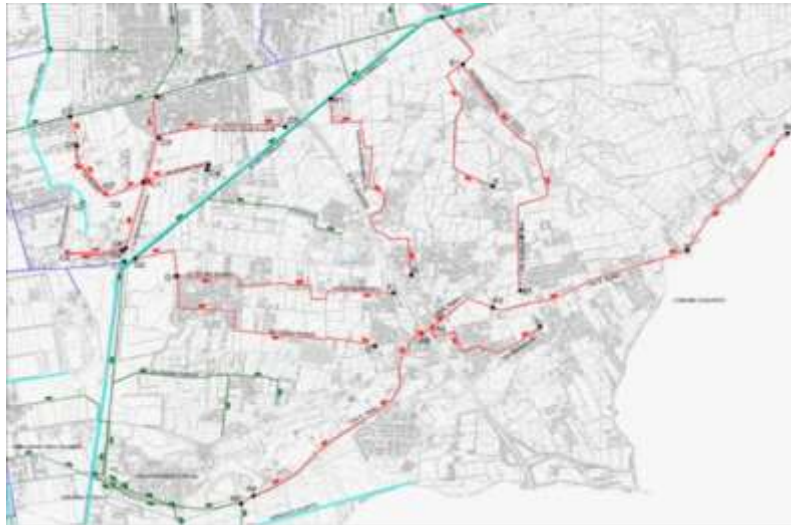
Planimetria degli interventi – Progetto Definitivo 2014
